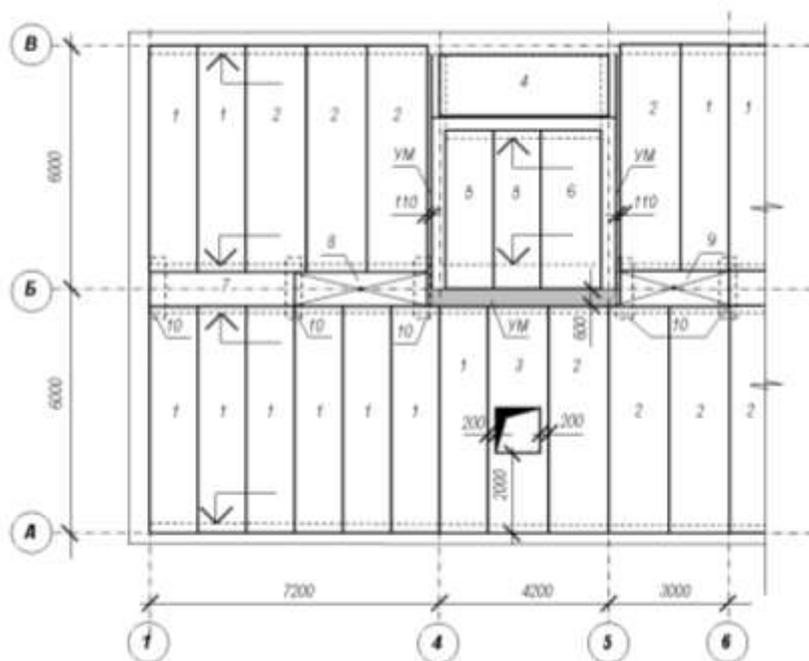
Пример оформления схемы расположения элементов покрытия
